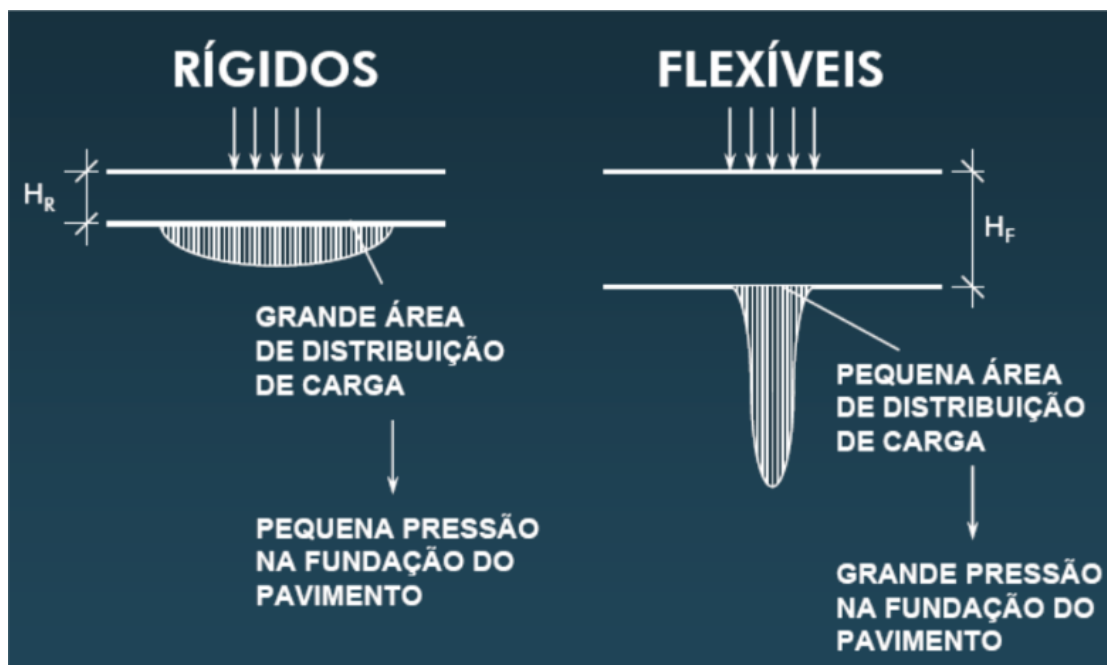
CARACTERÍSTICAS DOS PAVIMENTOS
